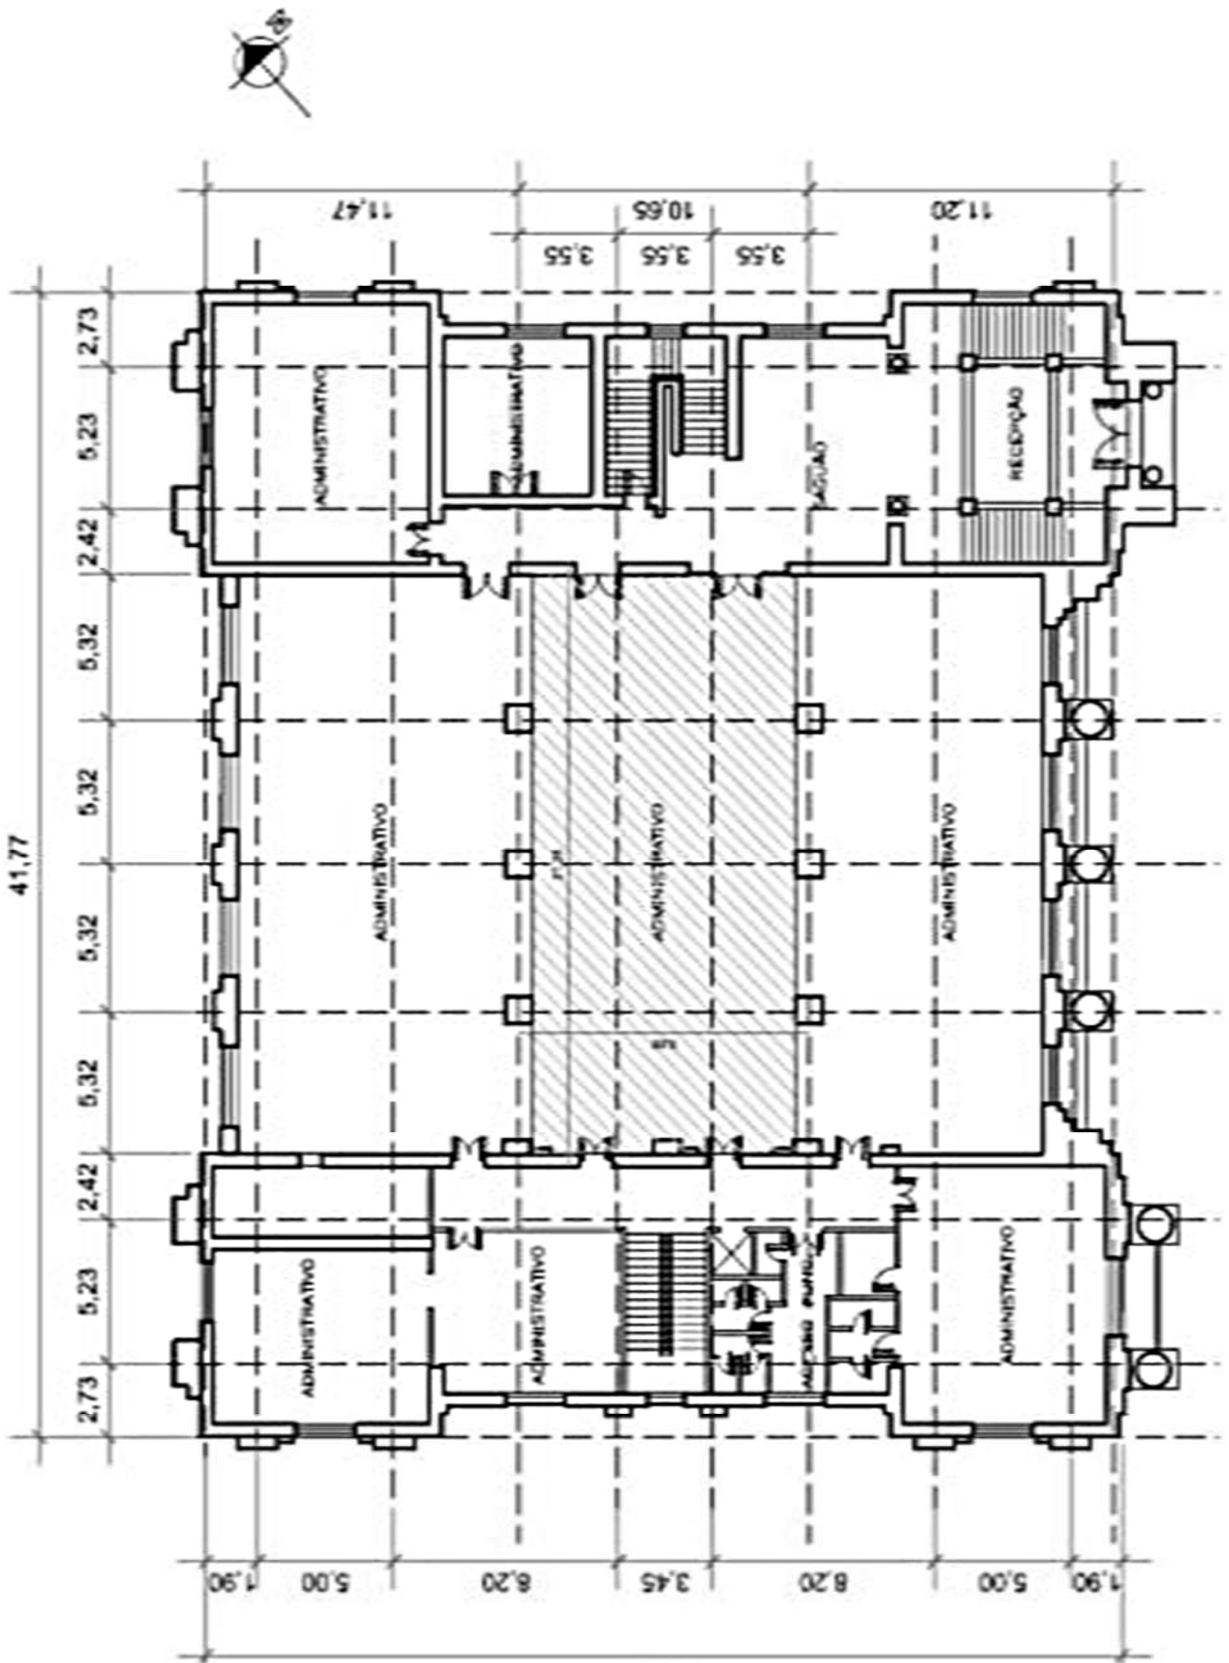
Modulação de projeto demarcada em redesenho da planta baixa térreo de Delegacia Fiscal (1916).
